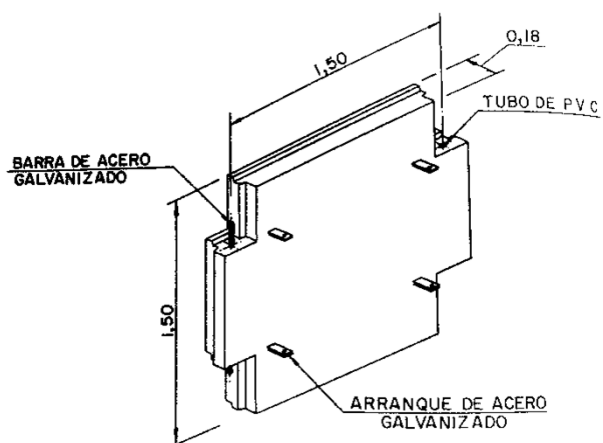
Panel prefabricado de concreto de fachada de muros de suelo reforzado.
